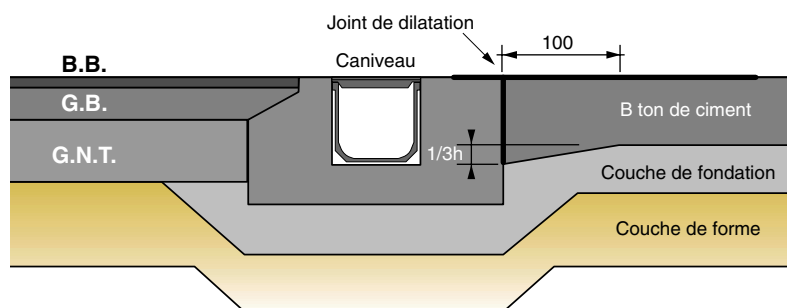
dispositions constructives pour réalisation d'un caniveau contre une bande de béton
